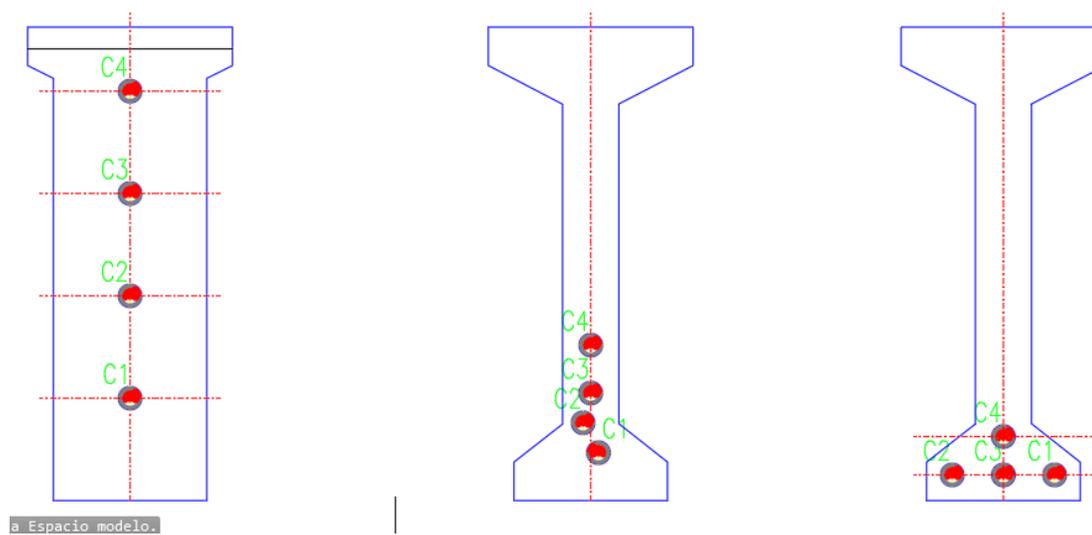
Secciones Convencionales de Puentes de Concreto Armado con Ductos para Tensionamiento.
